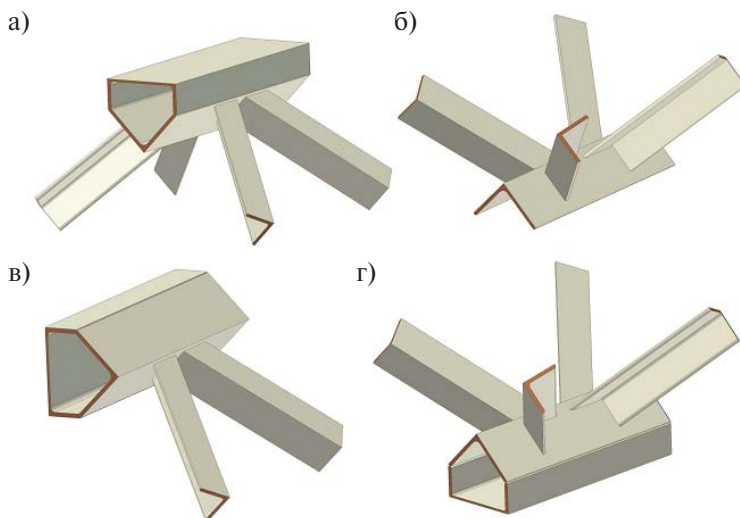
Бесфасоночное сопряжение раскосной решетки с поясами:
